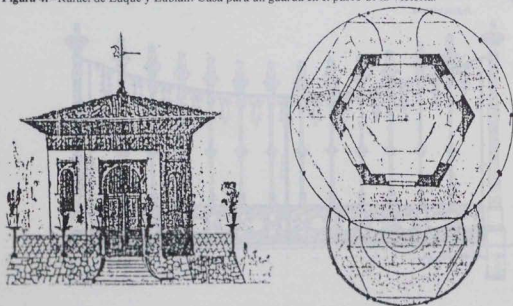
Amadeo Rodríguez: Planta y alzado de la caseta que se proyectó construir en los jardines de la Agricultura.
